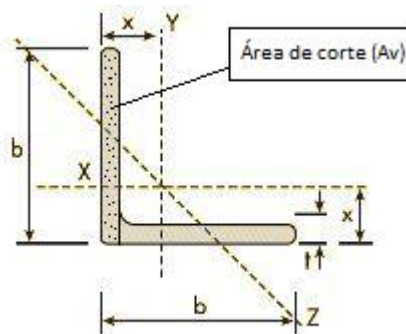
Área de corte (A_v) da cantoneira (Adaptado de www.samiaco.com.br)
